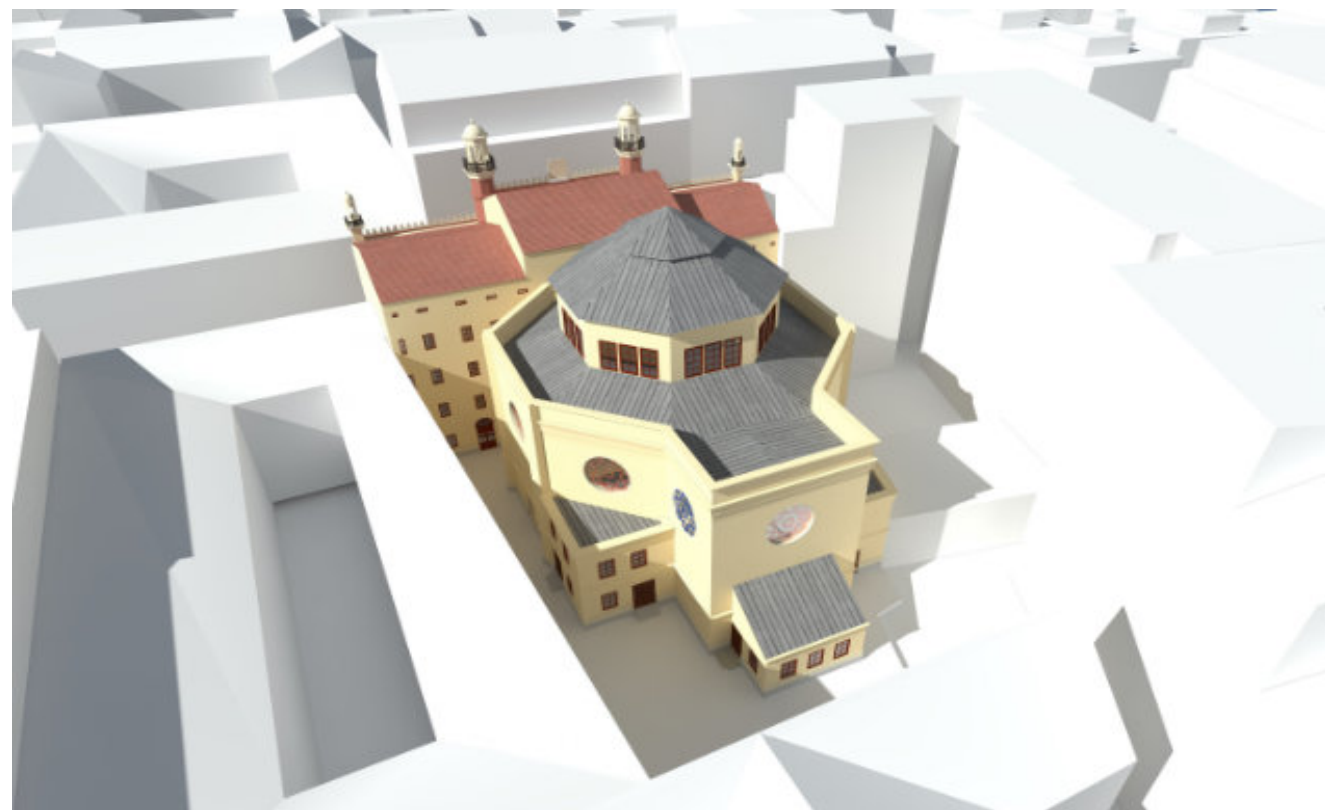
2.: Außen 04 und 05 - Südfassade und Dach, Städtebauliche Situation mit Blick Richtung Donau, Visualisierung.
